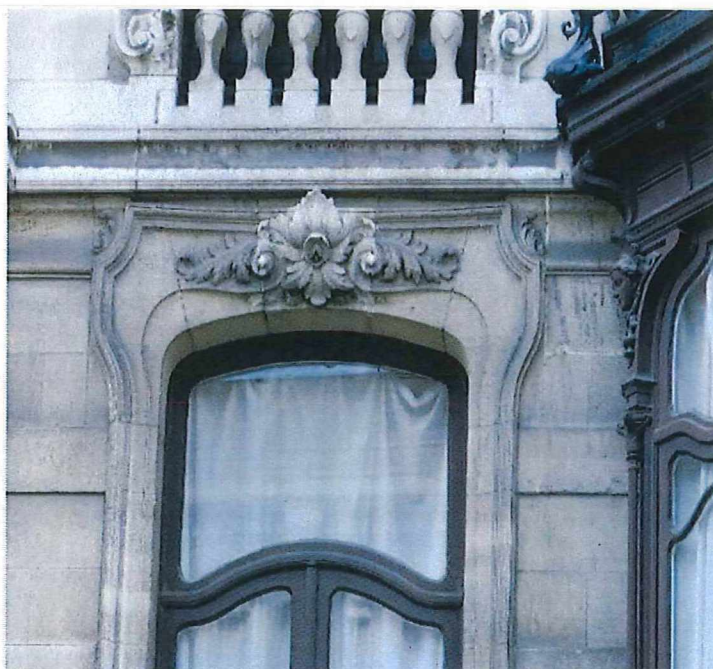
Detail oorspronkelijk houtwerk en decoratieve uitwerking van natuursteen.
